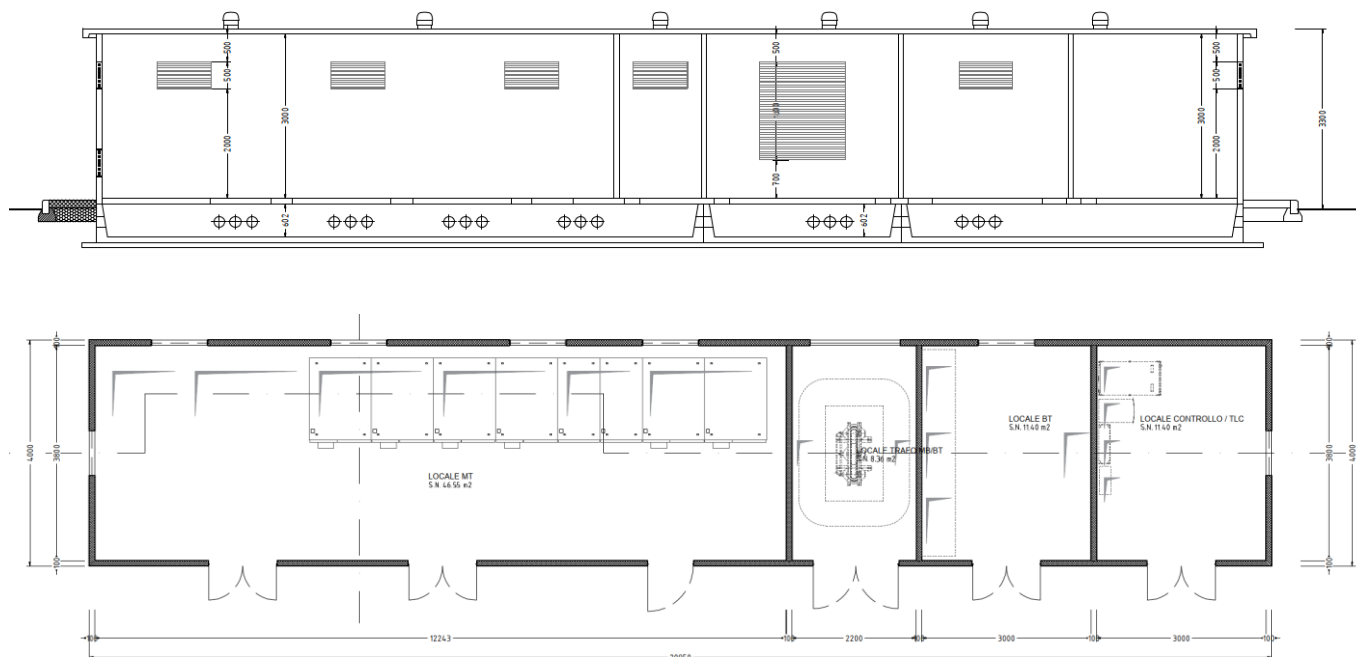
Cabina di campo viste in sezione e in pianta (CC)
